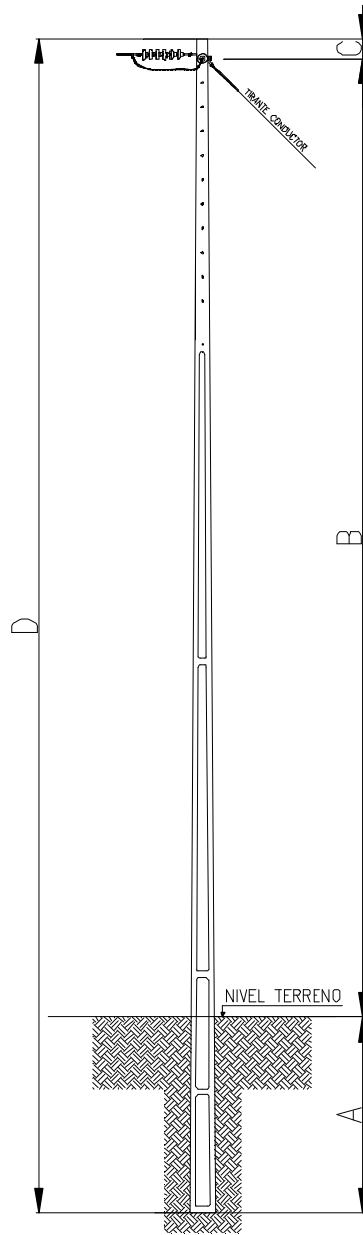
Geometría de estructura de anclaje tipo PQR 60-90.
